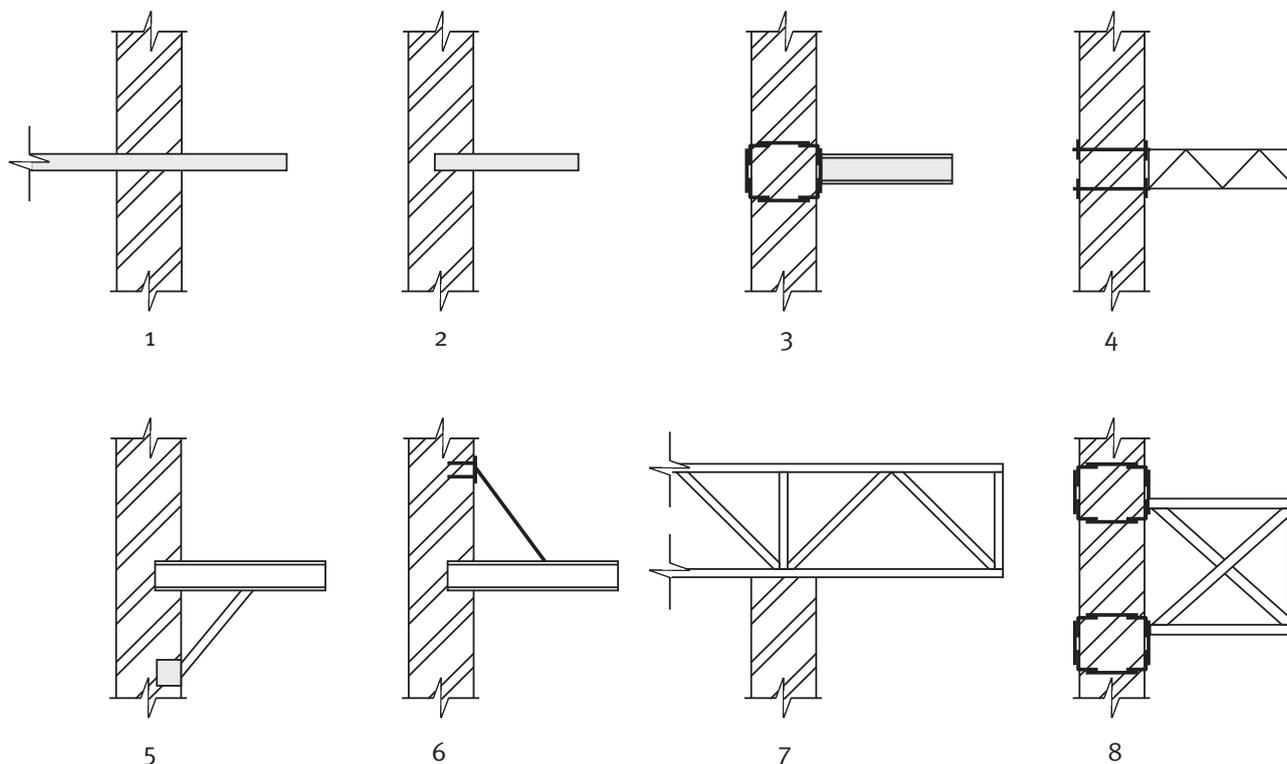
Типы организации консолей от стен в условиях реконструкции: участками плит перекрытий: 1 – с пропусканием через стену; 2 – заземлением в нее; 3 – сплошными балками к сталекирпичному ригелю; 4 – решетчатыми ригелями со сквозными шпильками и пластинами; 5 – балками с подкосами к монолитному поясу; 6 – подвесами к пластине на химических анкерах; 7 – аутригерами поверх стен; 8 – аутригерами к сталебетонным ригелям
